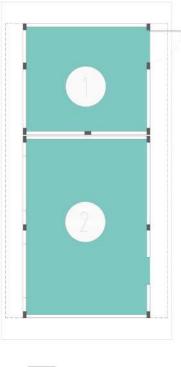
Planta 1 Bloque 36. Fuente: Equipo de diagnóstico.
